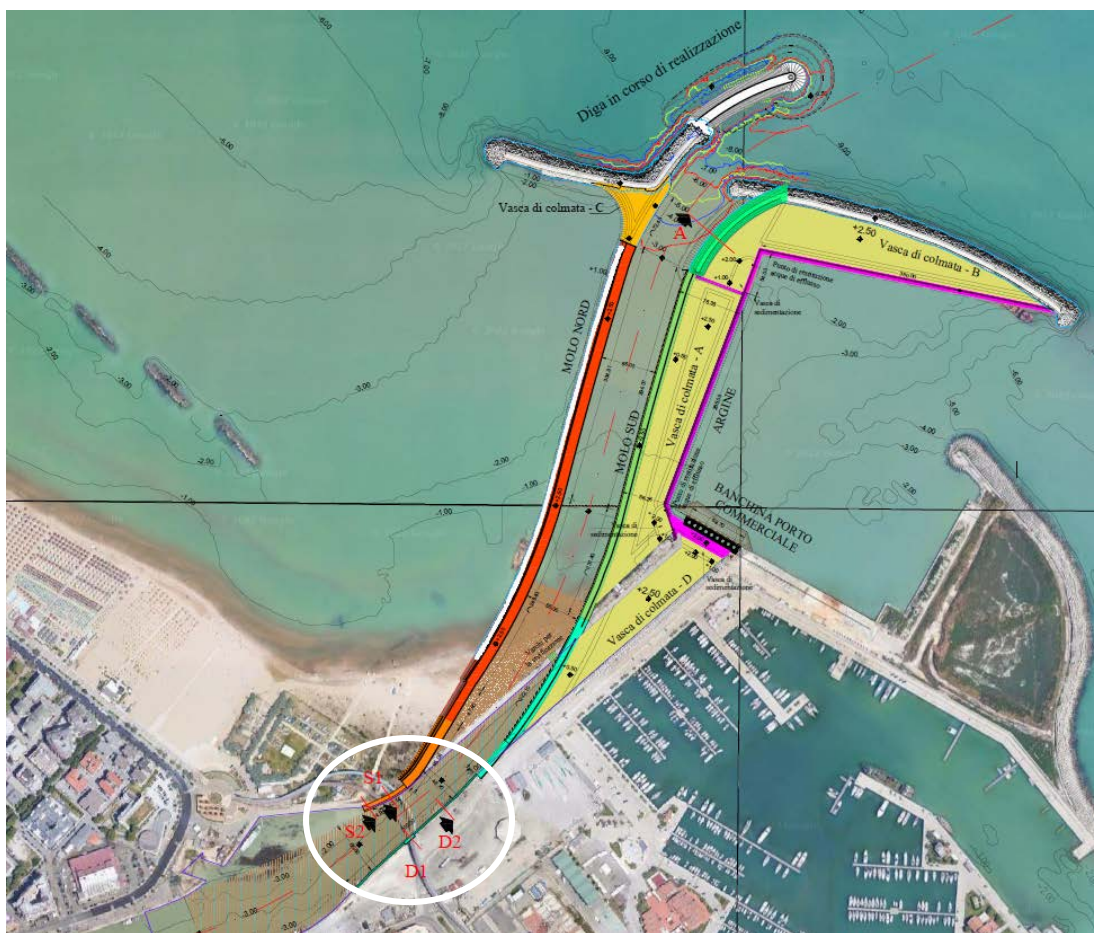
Planimetria con Sezioni S1, S2, D1, D2
